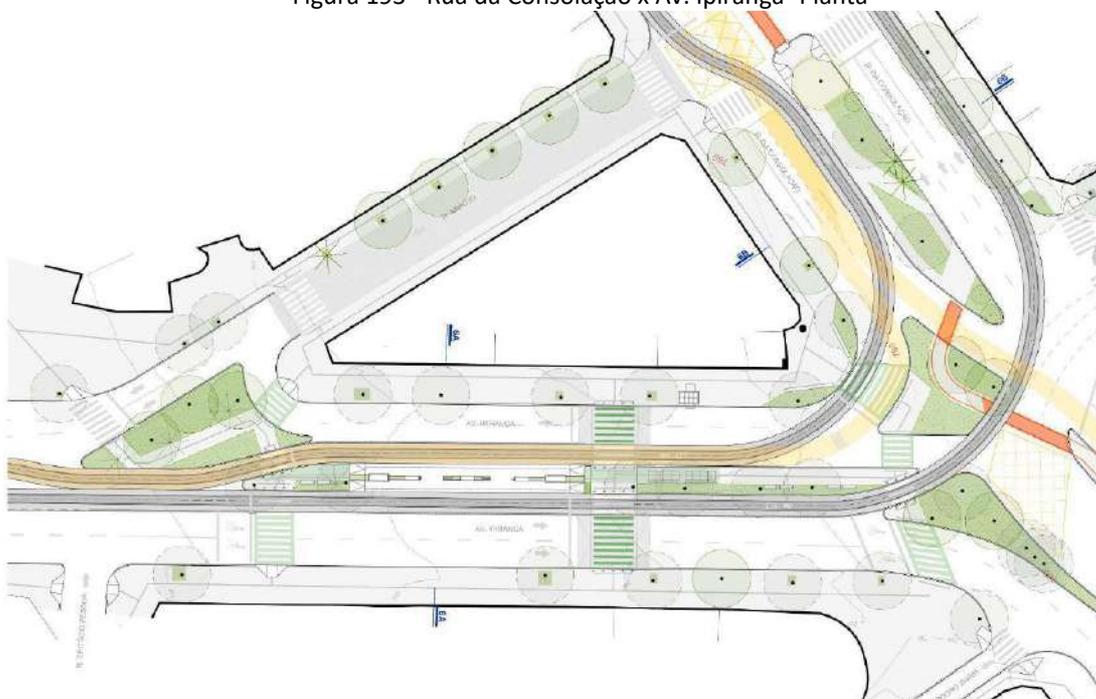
Rua da Consolação x Av. Ipiranga- Planta
